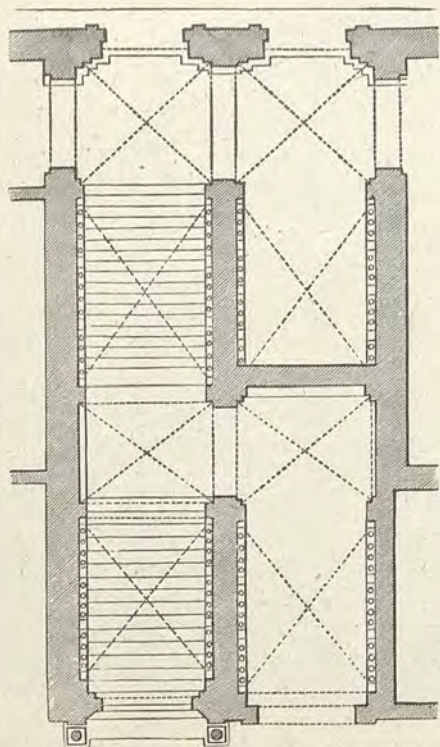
Pianta dello scalone del Palazzo Ducale di Venezia.
